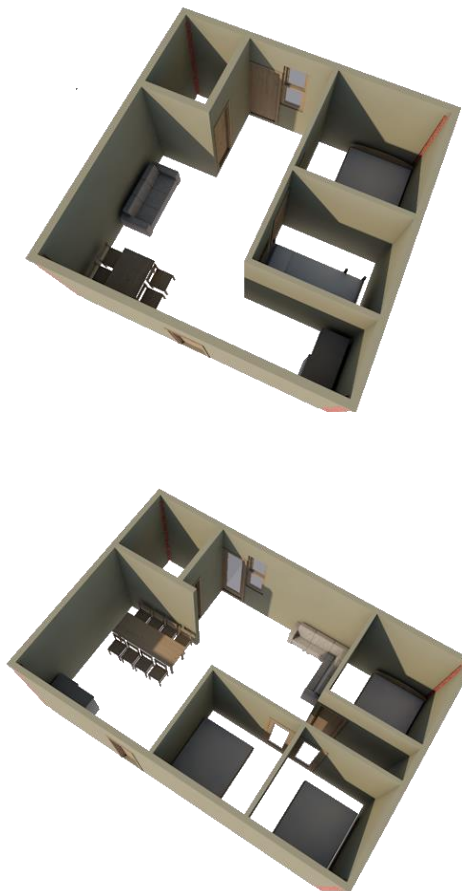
Denah Lantai 2, 4, 6 (tipikal)
